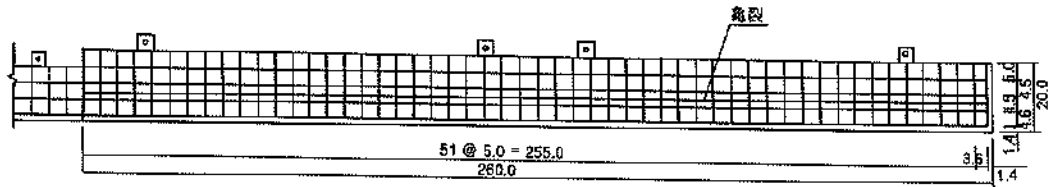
被災状況平面図 (十勝港, ①岸壁(南-7.5m))
